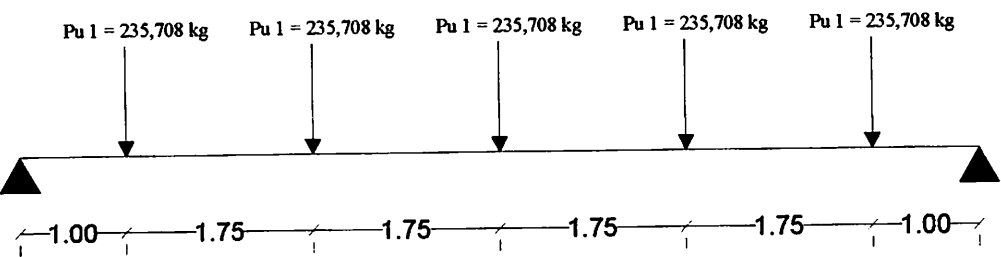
Beban mati lantai kendaraan dan trotoir
